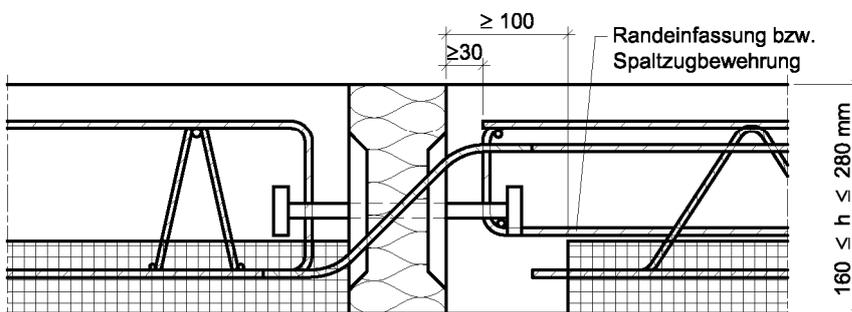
Beispiel Schöck Isokorb Typ Q mit Elementplatten
